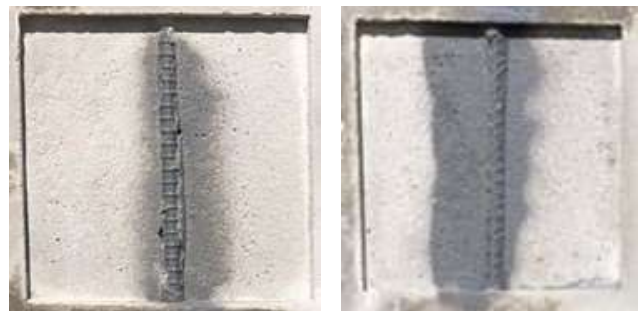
プライマーと防錆剤を使用した断面修復箇所の例
